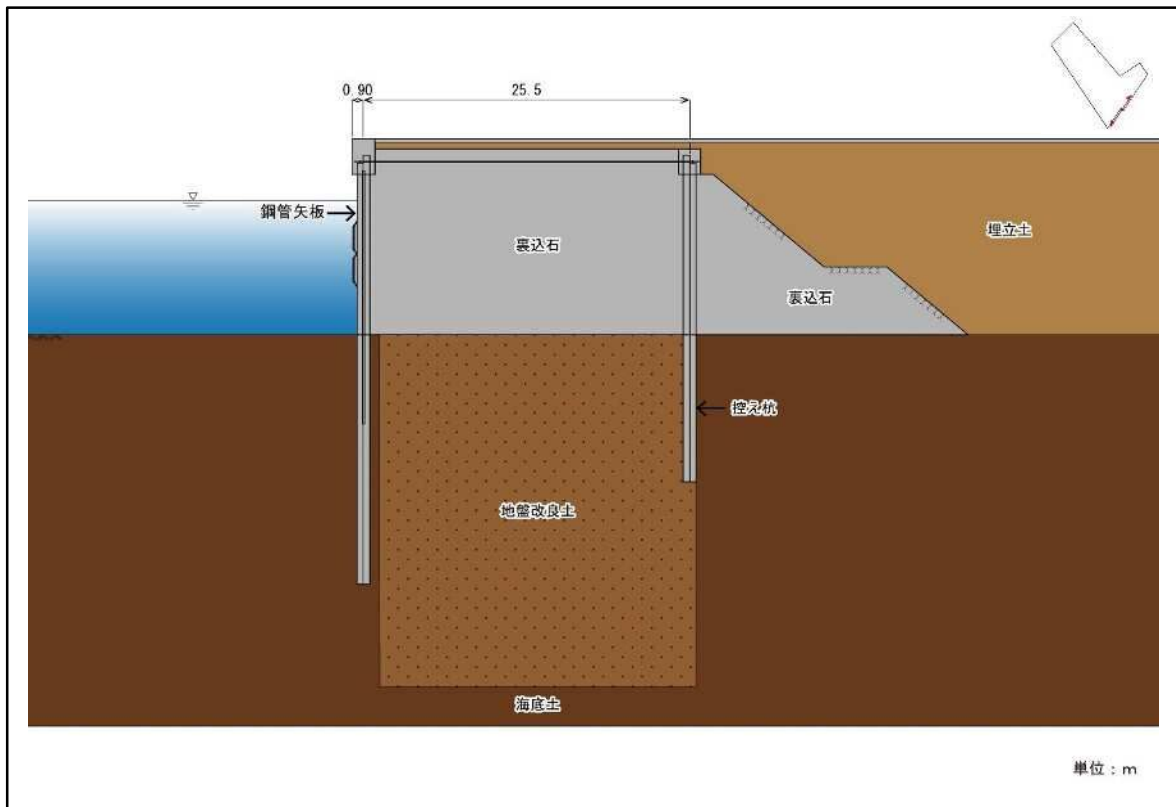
(3) 護岸③（棲部）の標準断面図
